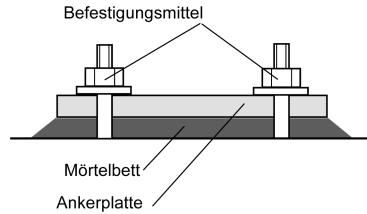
Ankerplatte mit Mörtelausgleichsschicht
